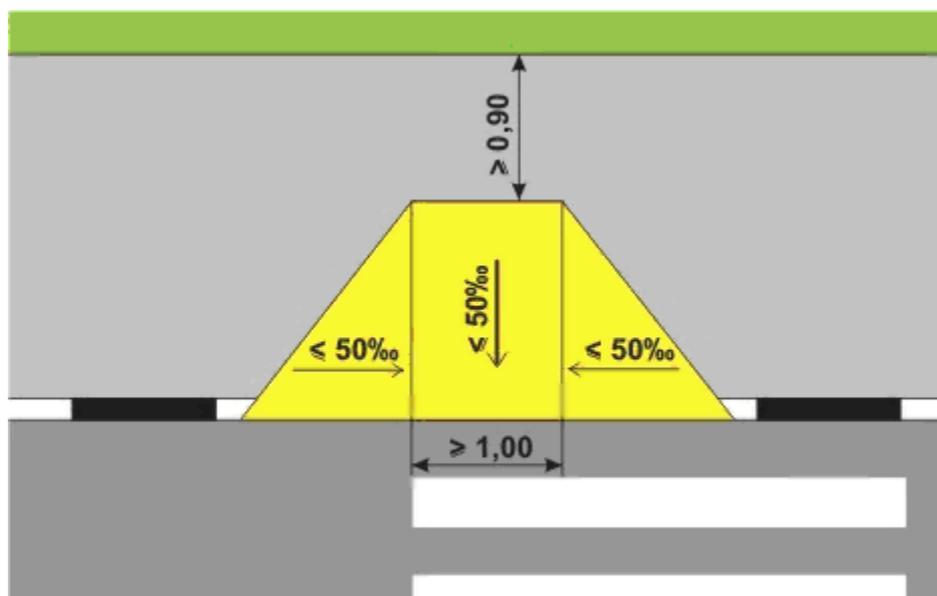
Вариант размещения пандусов на отнесенных пешеходных переходах и пешеходных переходах, располагаемых на перегонах
